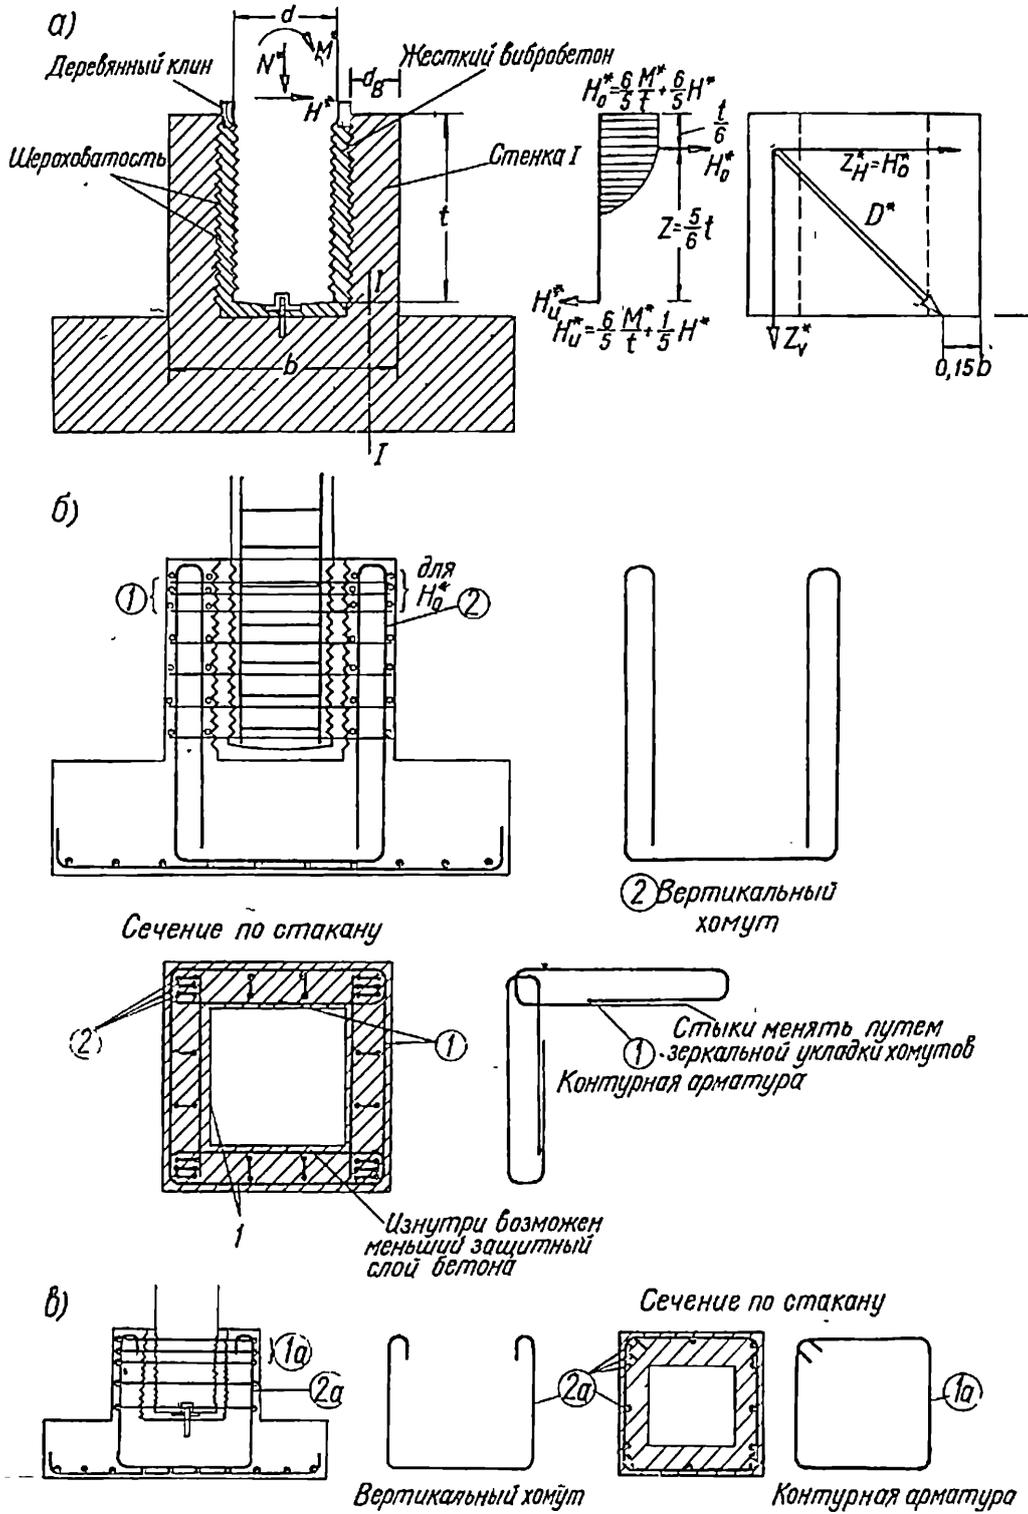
14. Расчет и армирование фундаментов стаканного типа
